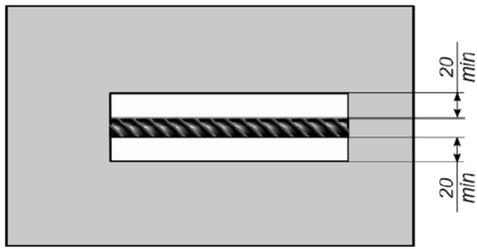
Схема нарезки штраб вдоль арматуры
